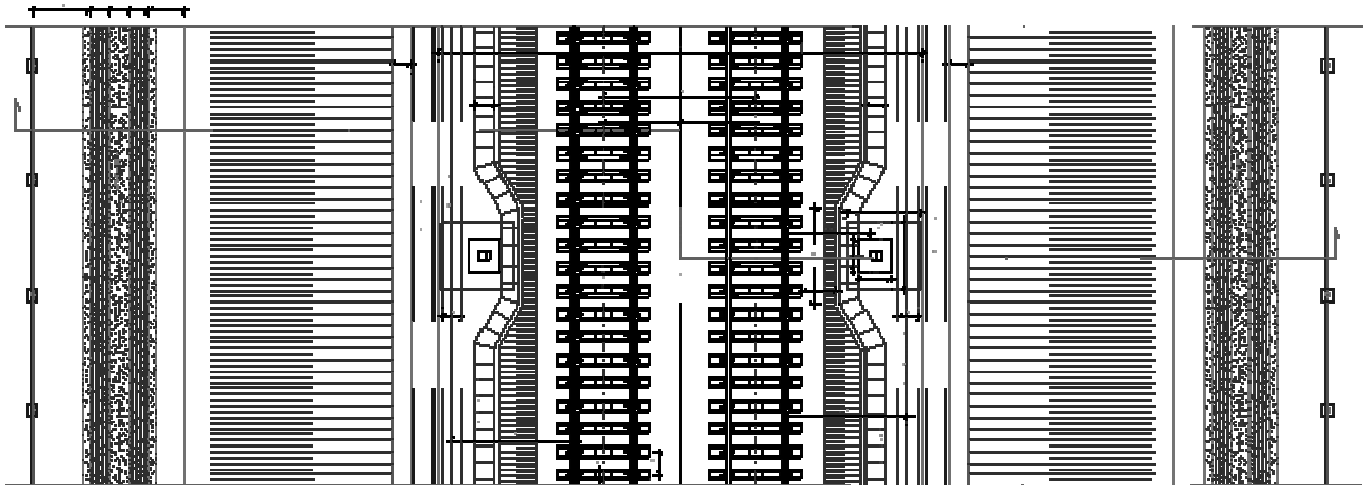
Stralcio planimetrico con sezione tipo ferroviaria in trincea a doppio binario in rettilineo
